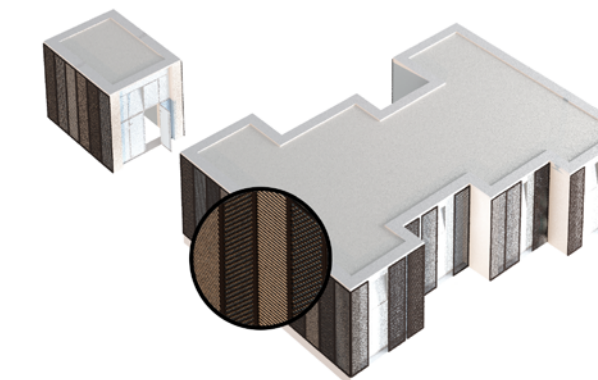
Dettaglio sul blocchetto Street Food del sistema di frangisole
